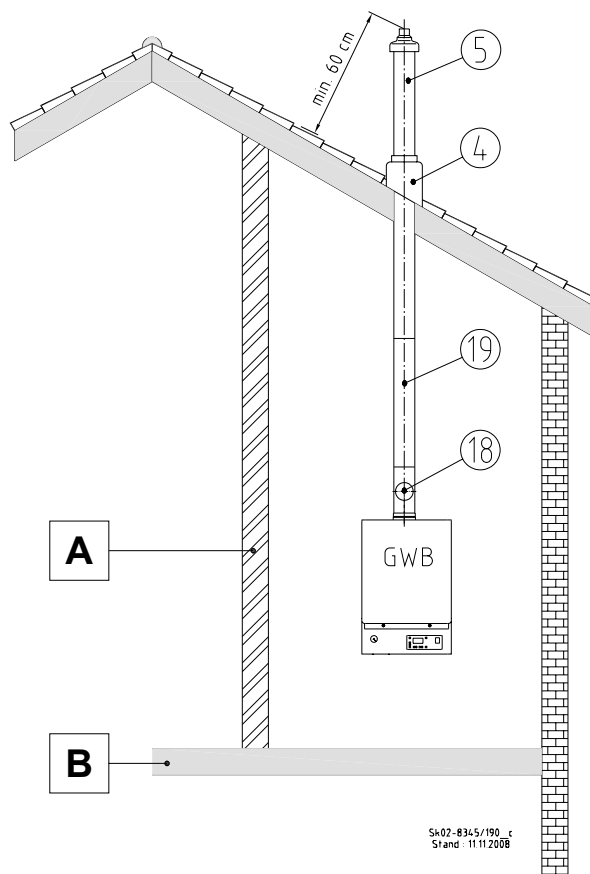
Centrala dachowa z przejściem przez strop i dach.
